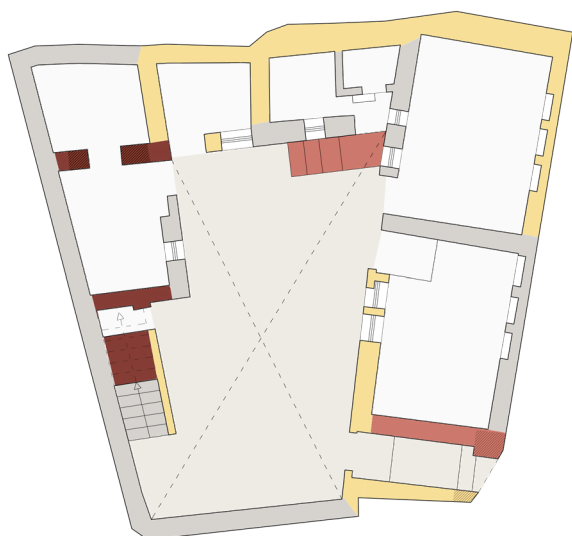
Stato strutturale delle pareti in piano terra | Scala 1/200
